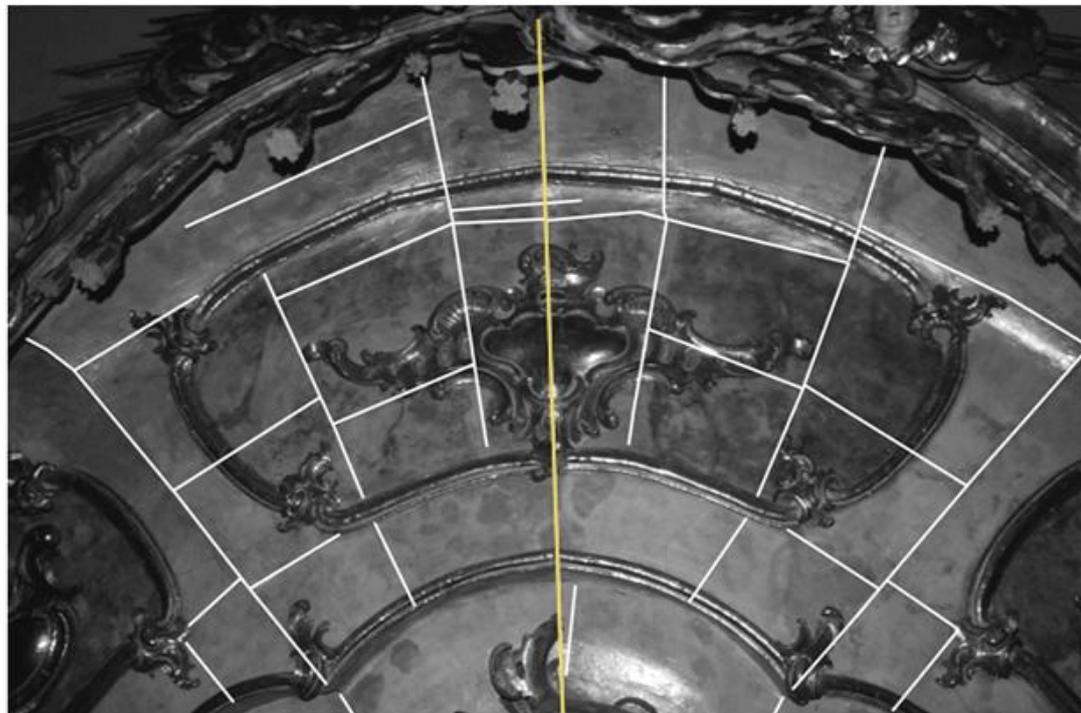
Südliches Retabel, Schauseite Baldachin.
